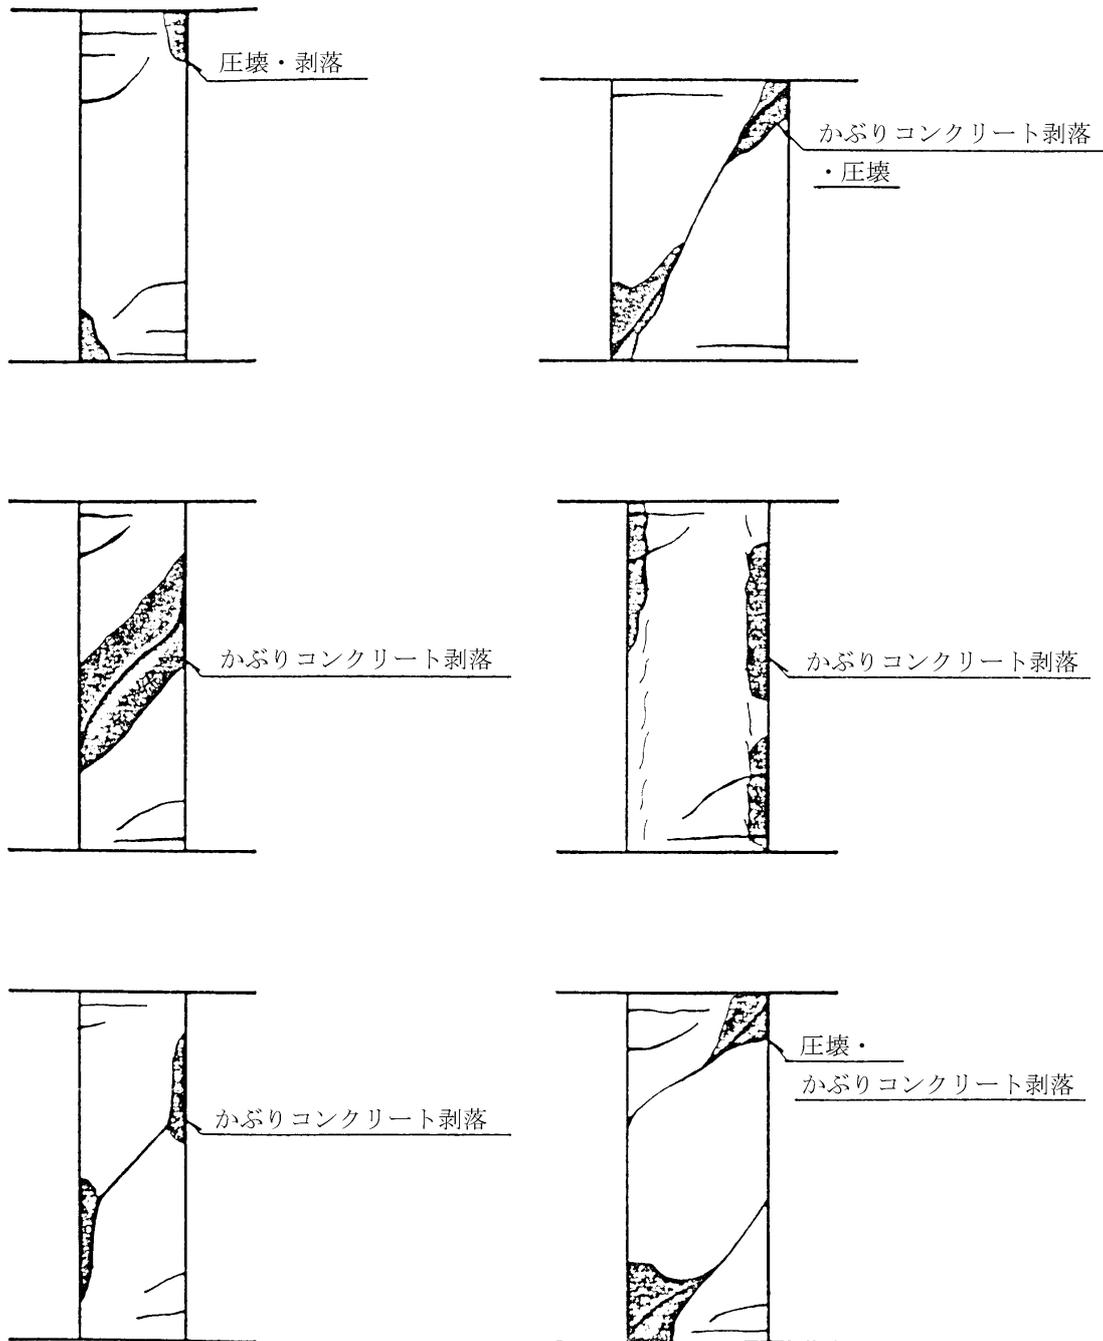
鉄筋コンクリート造：ひび割れのパターン
